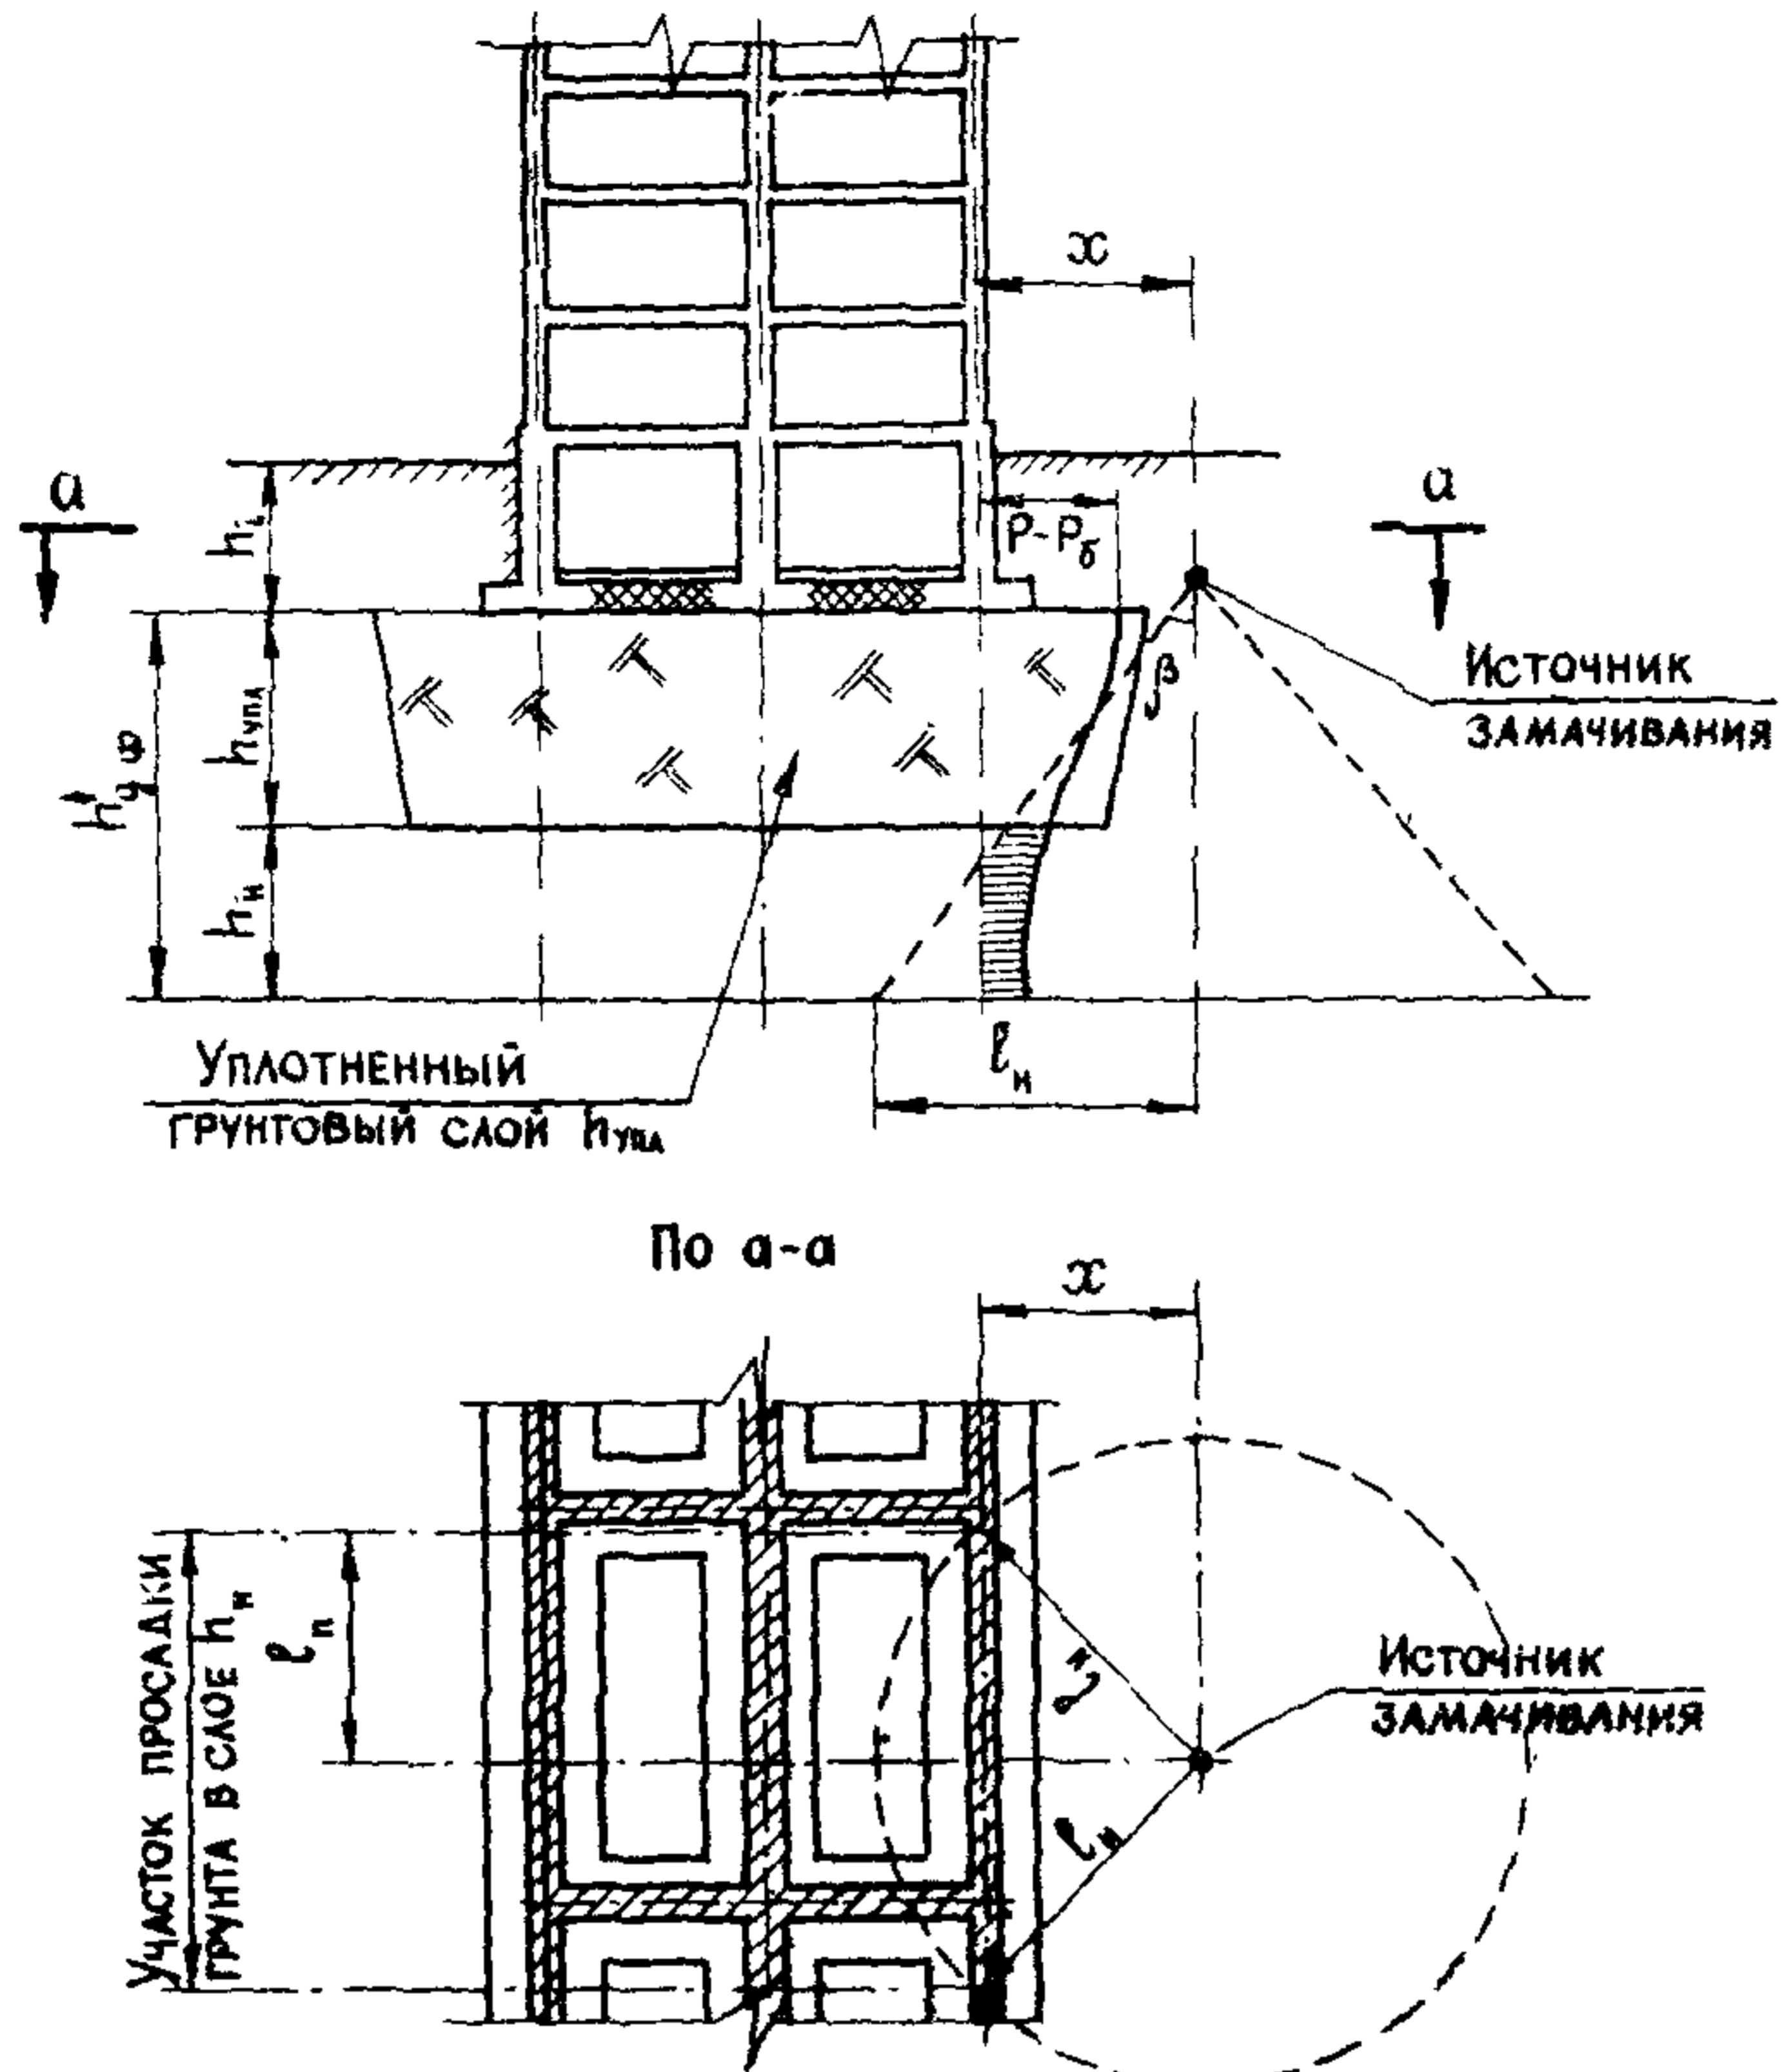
Схема для определения полудлины участка не равномерной просадки грунта от нагрузки фундаментов.
